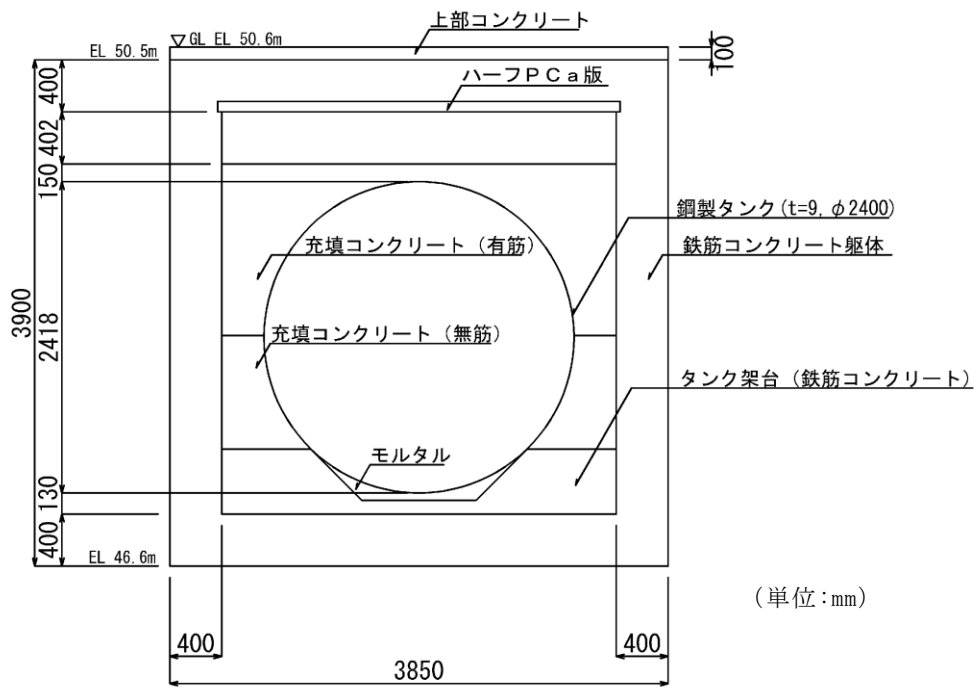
緊急時対策所用燃料地下タンク 断面図 (A-A 断面)
